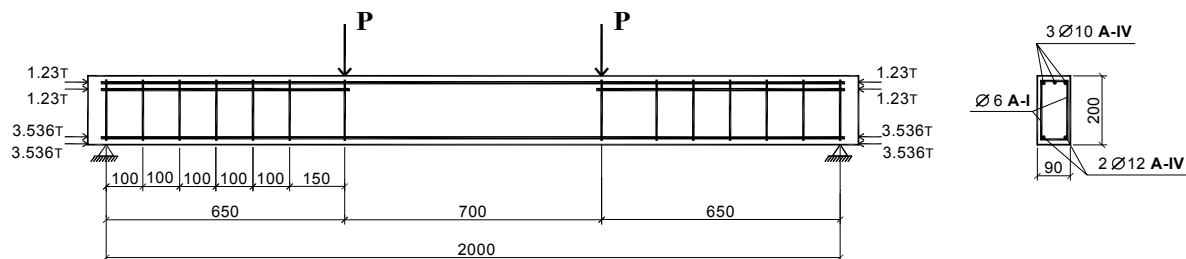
Конструкция предварительно напряженной балки прямоугольного сечения
